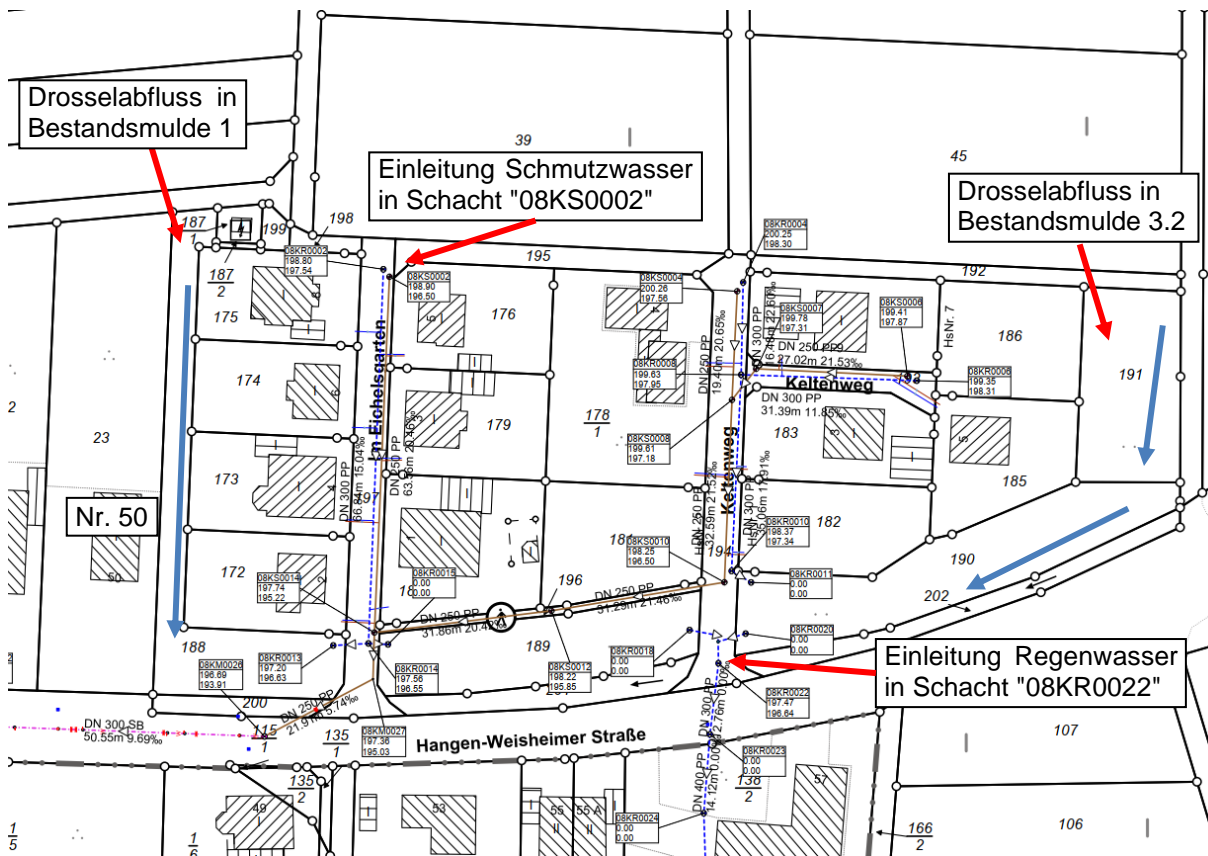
Lageplan Anschlusspunkte Schmutz- & Regenwasserkanal - Bestandsableitung zum Gewässer
